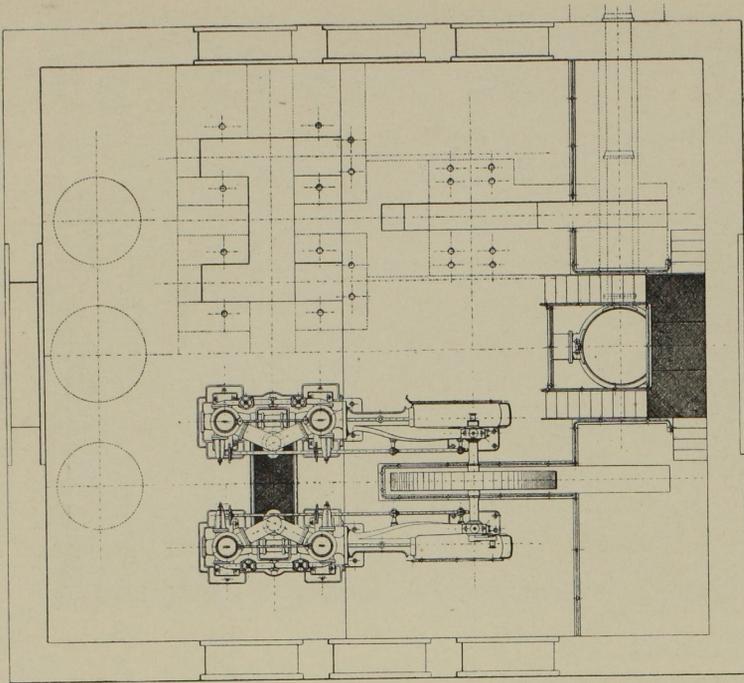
Grundriss der Gesamtanlage. Massst. 1:50.
